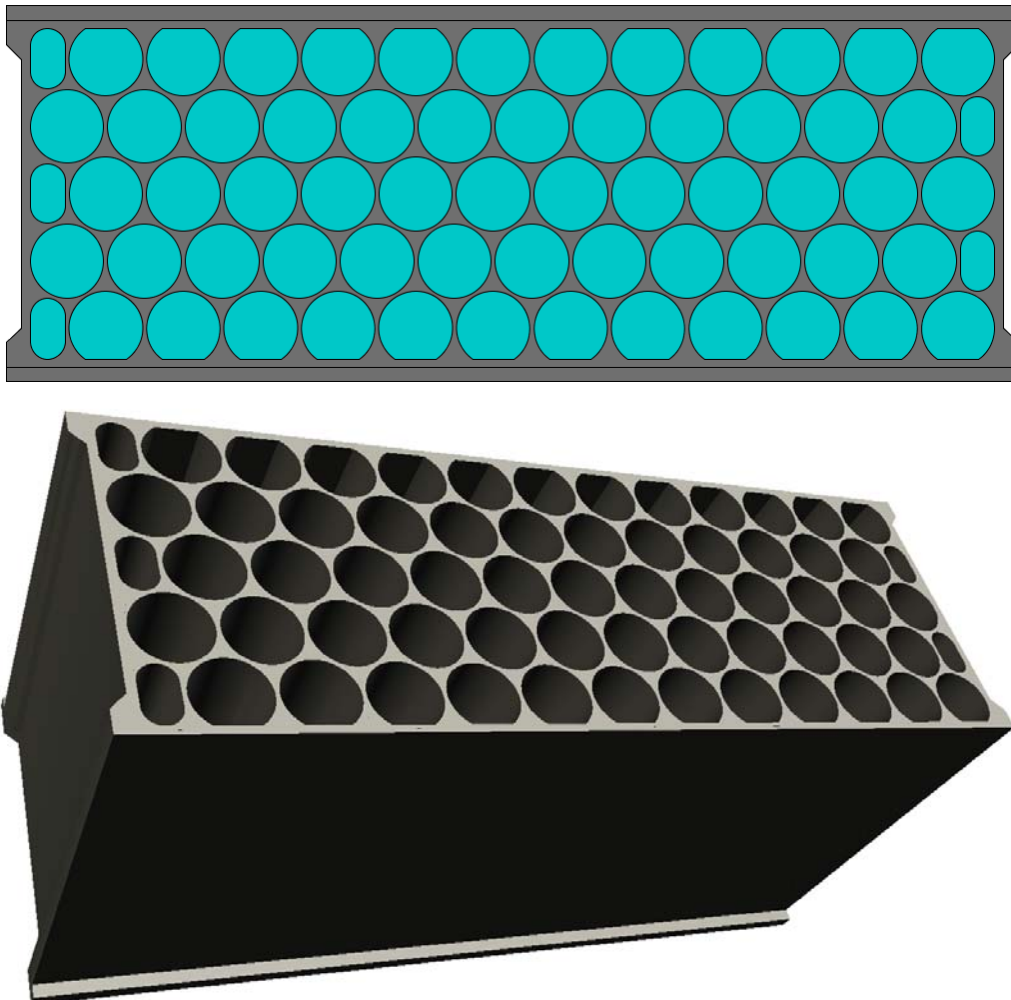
Vista general en planta y en 3D de un cajón flotante
